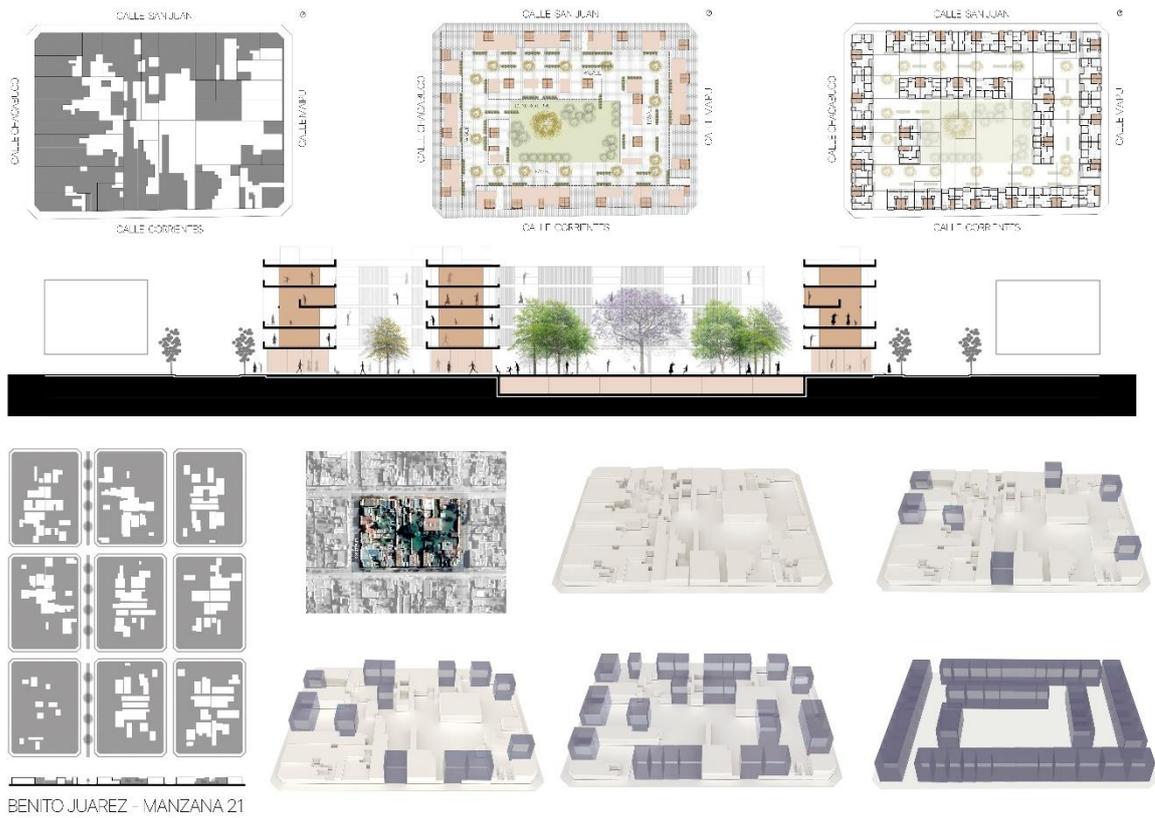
Prefiguración en la Manzana. Benito Juárez. Fuente: autora Arq. Juana Prieto.
